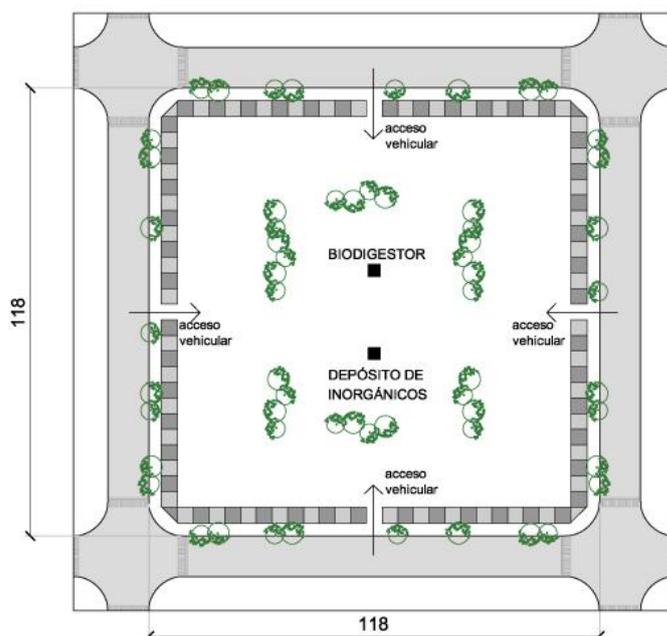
Esquema en planta del Complejo Habitacional de Viviendas
